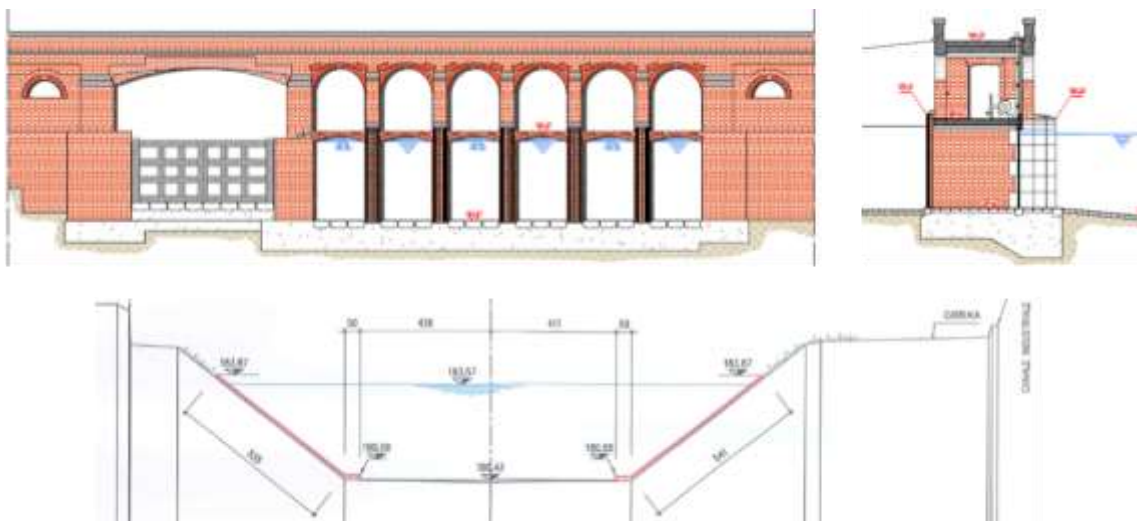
Incile Canale Villoresi a Panperduto: prospetto (sinistra) e sezione (destra); sezione tipologica del canale (sotto).
